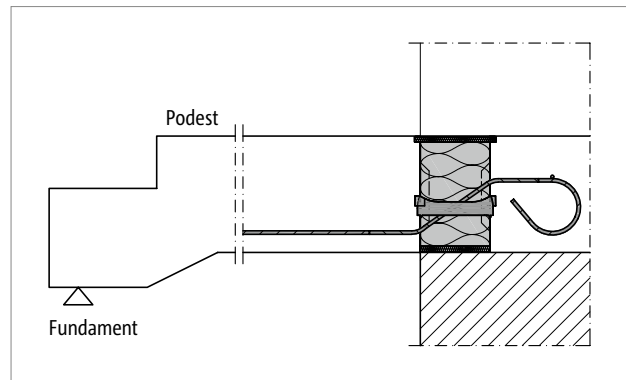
Schöck Isokorb® XT Typ QL: Anschluss Treppenpodest bei einschaligem, wärmedämmendem Mauerwerk (XT Typ QL-V1 bis V4)
